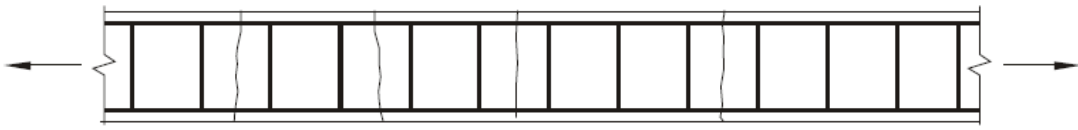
Fissuração em elemento estrutural tracionado
